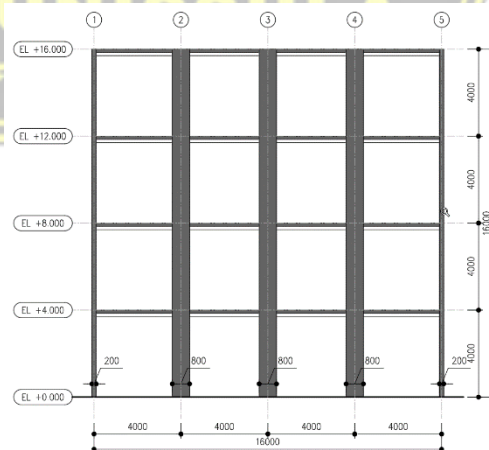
4. Potongan pada grid kolom pipih 150 mm × 1066 mm
